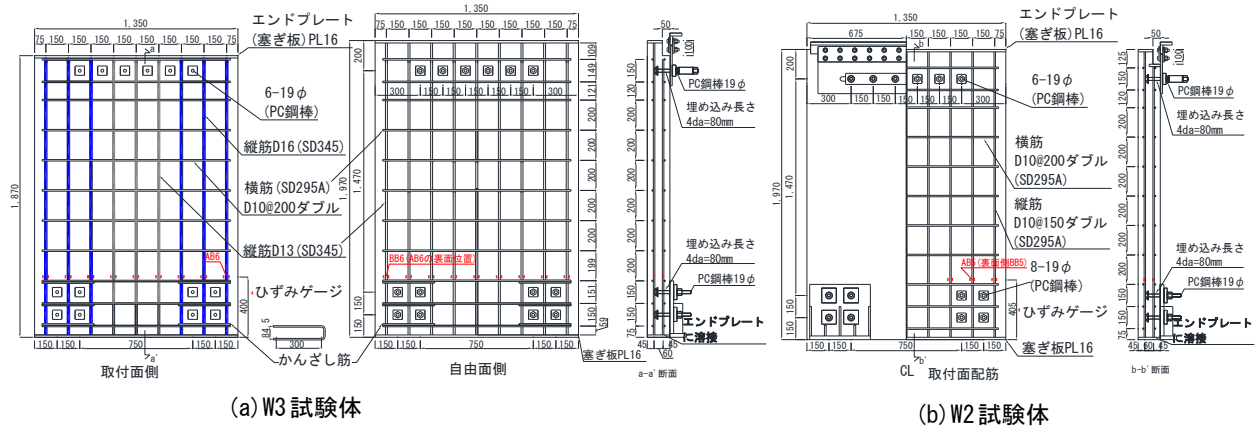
試験体の形状・寸法, 配筋, 及び縦筋ひずみ計測位置
